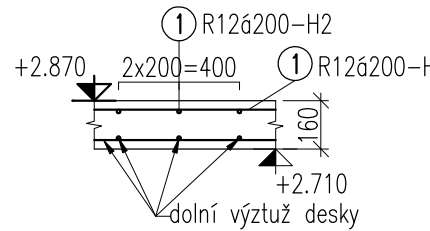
DETAIL STYKOVÁNÍ VÝZTUŽNÝCH PRUTŮ
